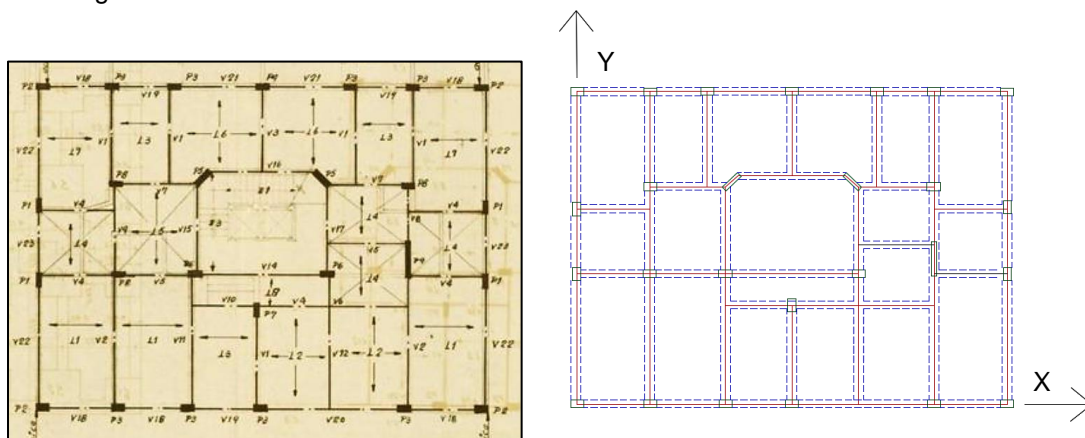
Planta do edifício tipo disponível no Arquivo Municipal (à esquerda); Traçado da planta do edifício tipo em AutoCAD (à direita)
